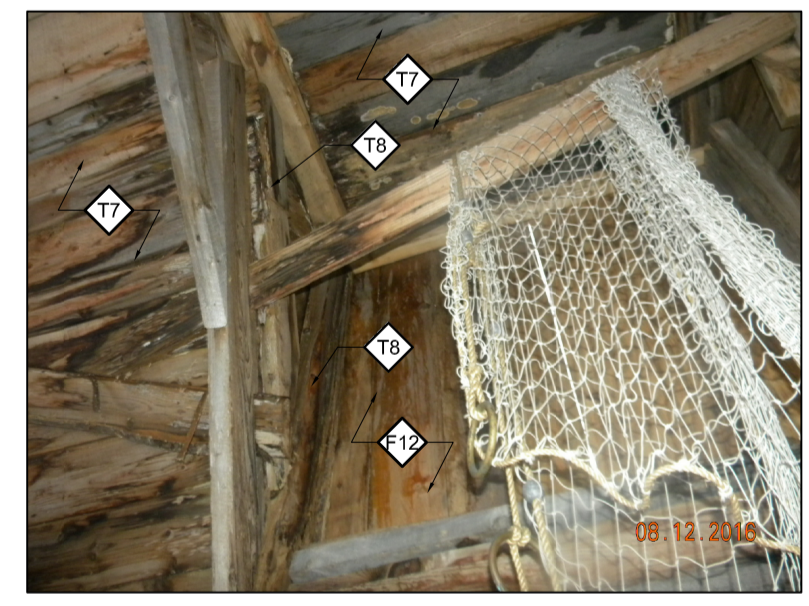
PLANCHE DE SUPPORT DE TOITURE À REMPLACER AU POURTOUR DE LA LUCARNE
